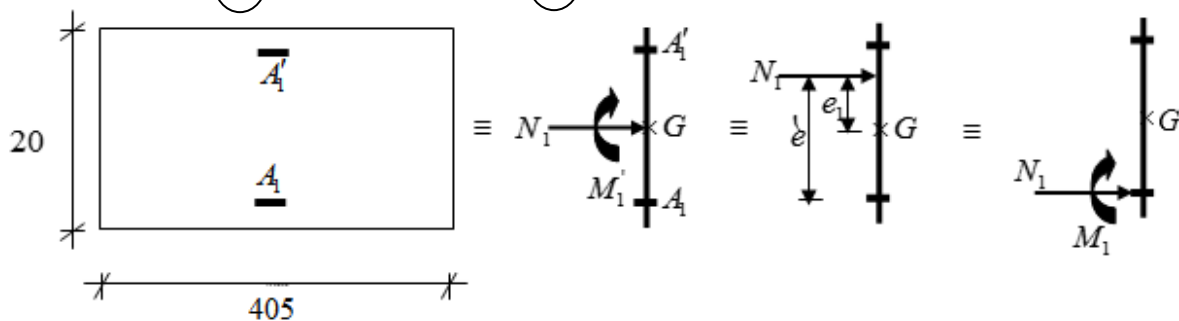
position de N_1 , M_1' et M_1 sur la section transversale
